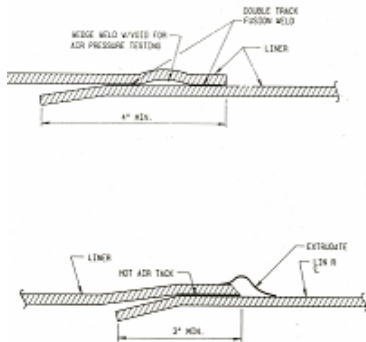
Uniones a) solape con canal de prueba, b) soldadura con aporte por extrusión
